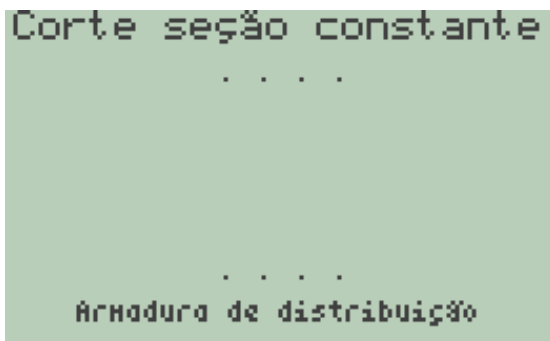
Viga alavanca - Detalhamento da armadura inferior.
